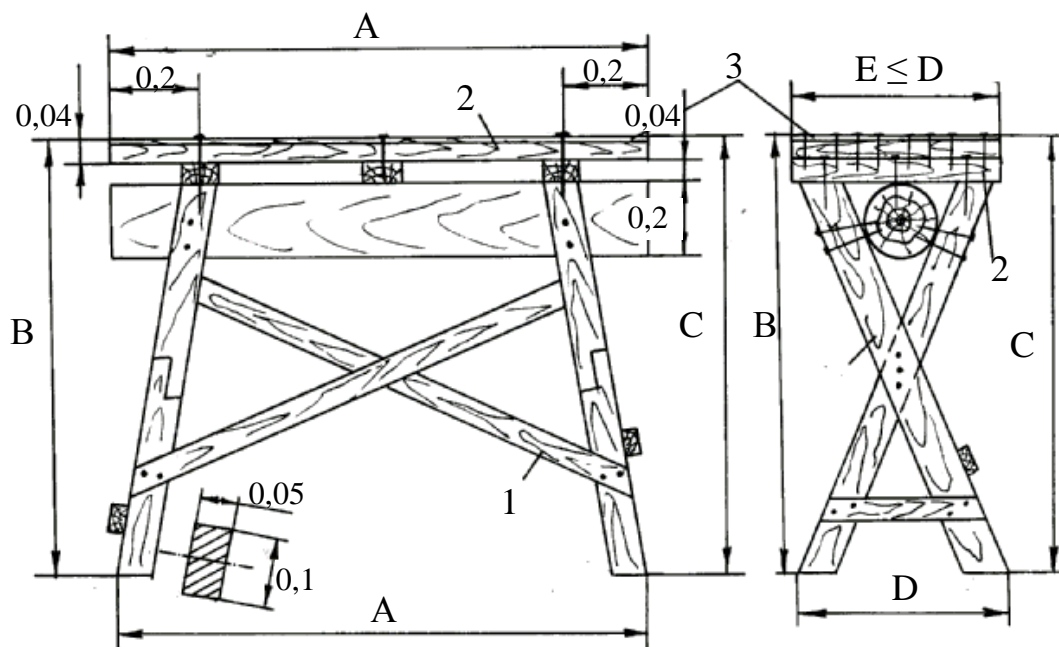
Конструкция универсального деревянного помоста (размеры в табл. 11.1): 1 – опорная часть (каркас); 2 – рабочая площадка; 3 – металлический лист
